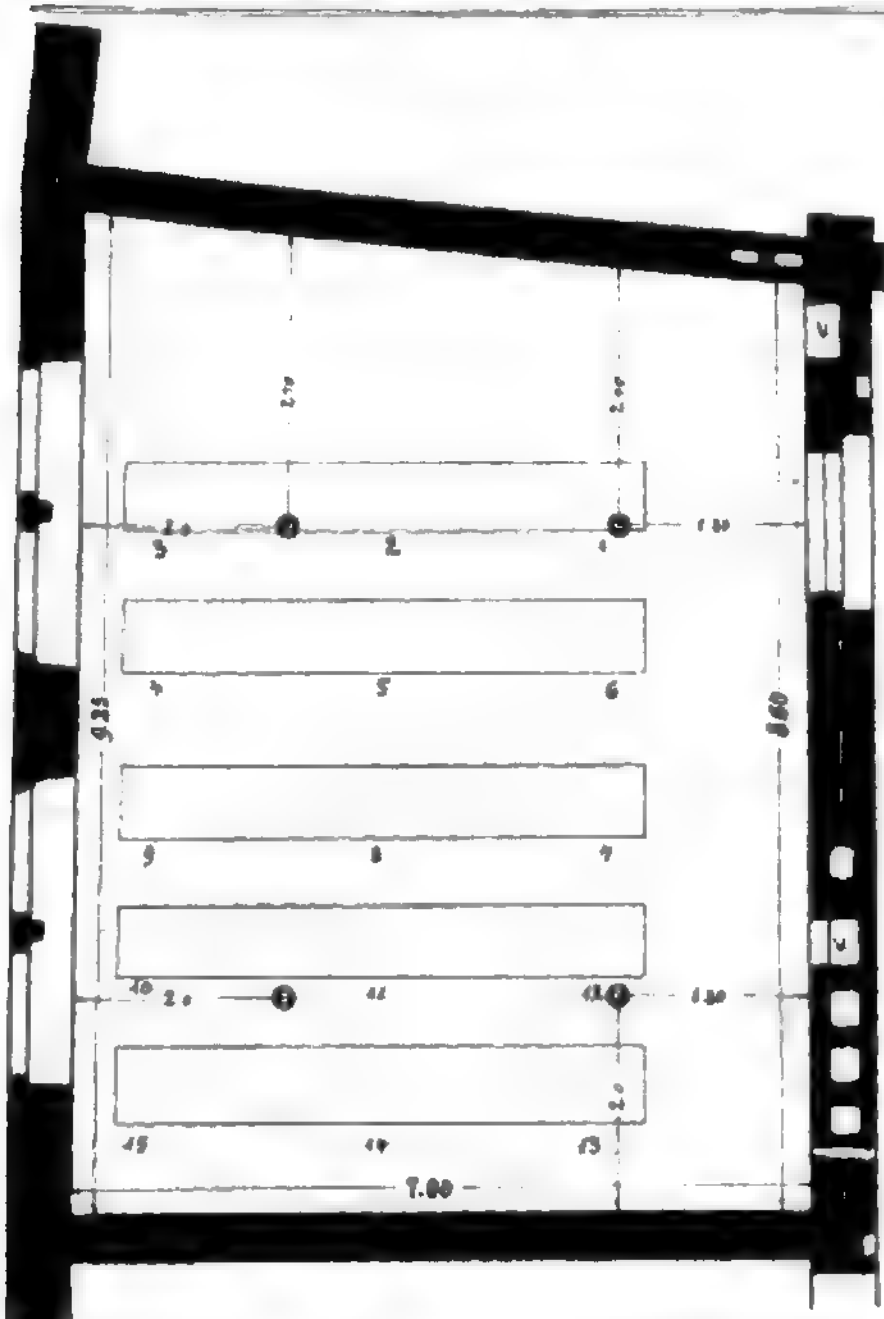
Saal I. Grundriss. Anordnung der Lampen und Messpunkte.
